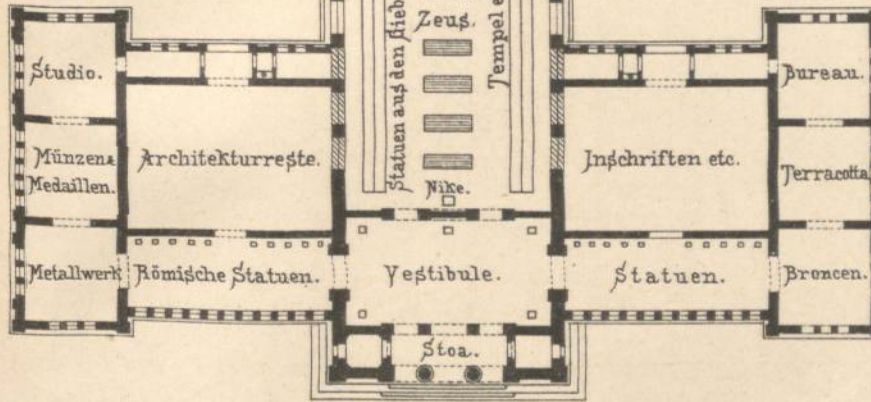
Erdgeschoss. Entwurf für Olympia. Ziller.
